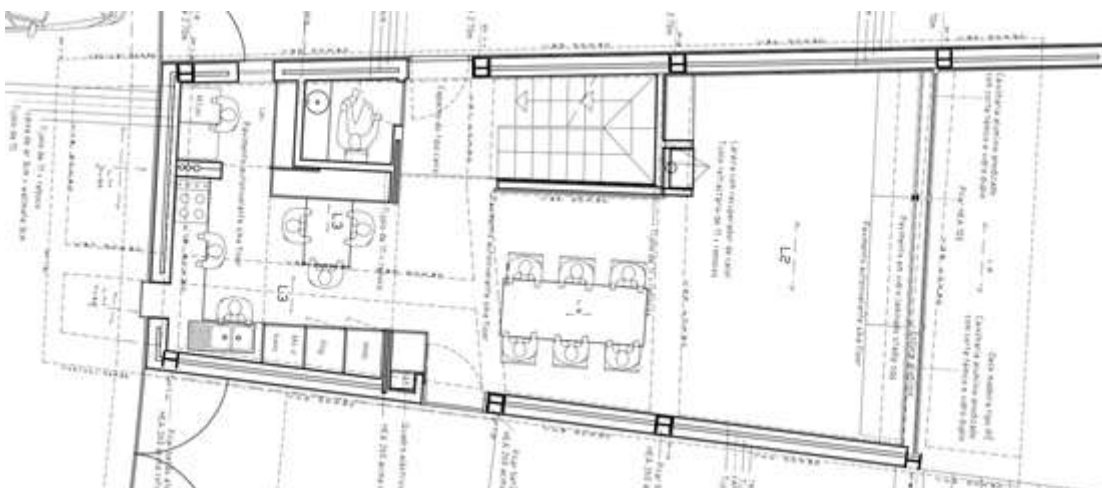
Peça desenhada do projeto com a planta arquitetónica e estrutural.
